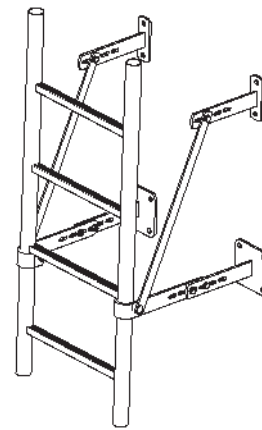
Wandbefestigung mit einem Paar Zugbänder
